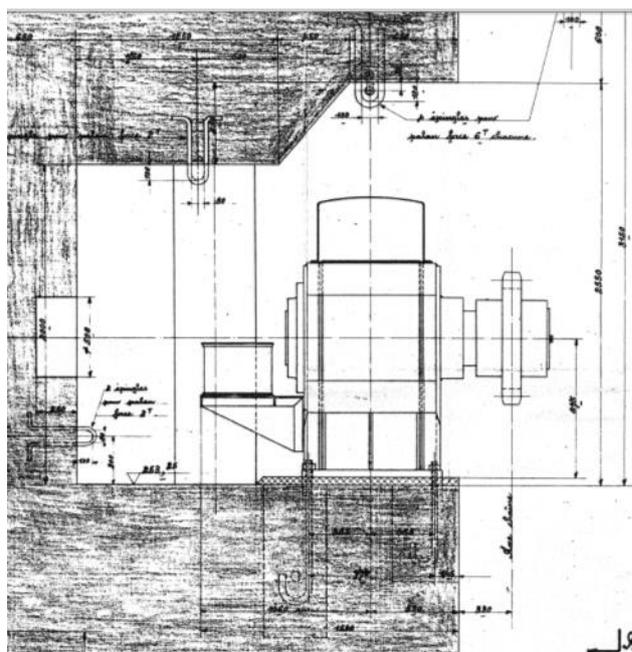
Coupe sur treuil d'origine - Plan N°44 460 de Bouchayet & Vallier de 1960
